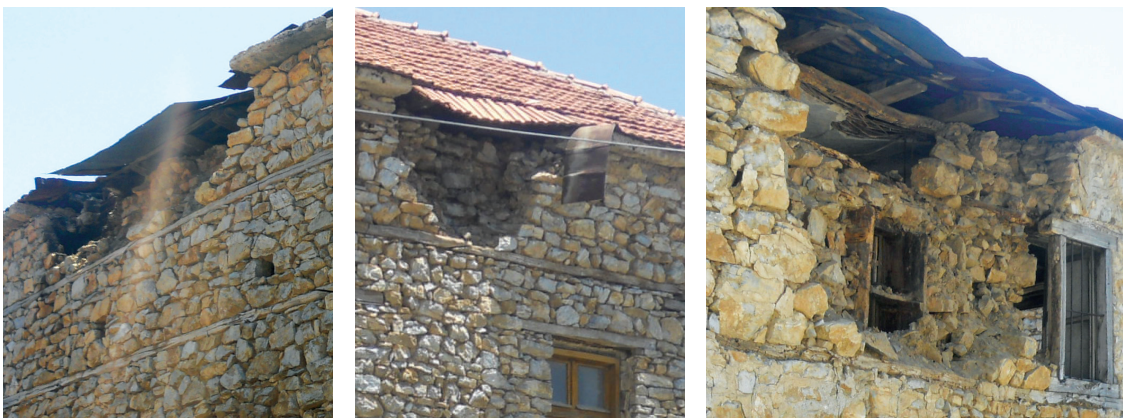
Renversement des pierres uniquement dans le segment horizontal de la maçonnerie situé au-dessous de la toiture (a,b) ou dans une portion du mur plus importante (c).
